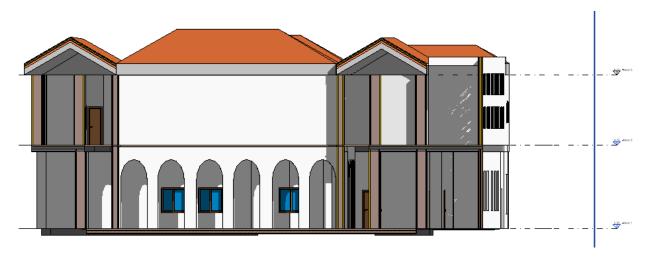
Plano de corte B – Fuente: Elaboración Propia
